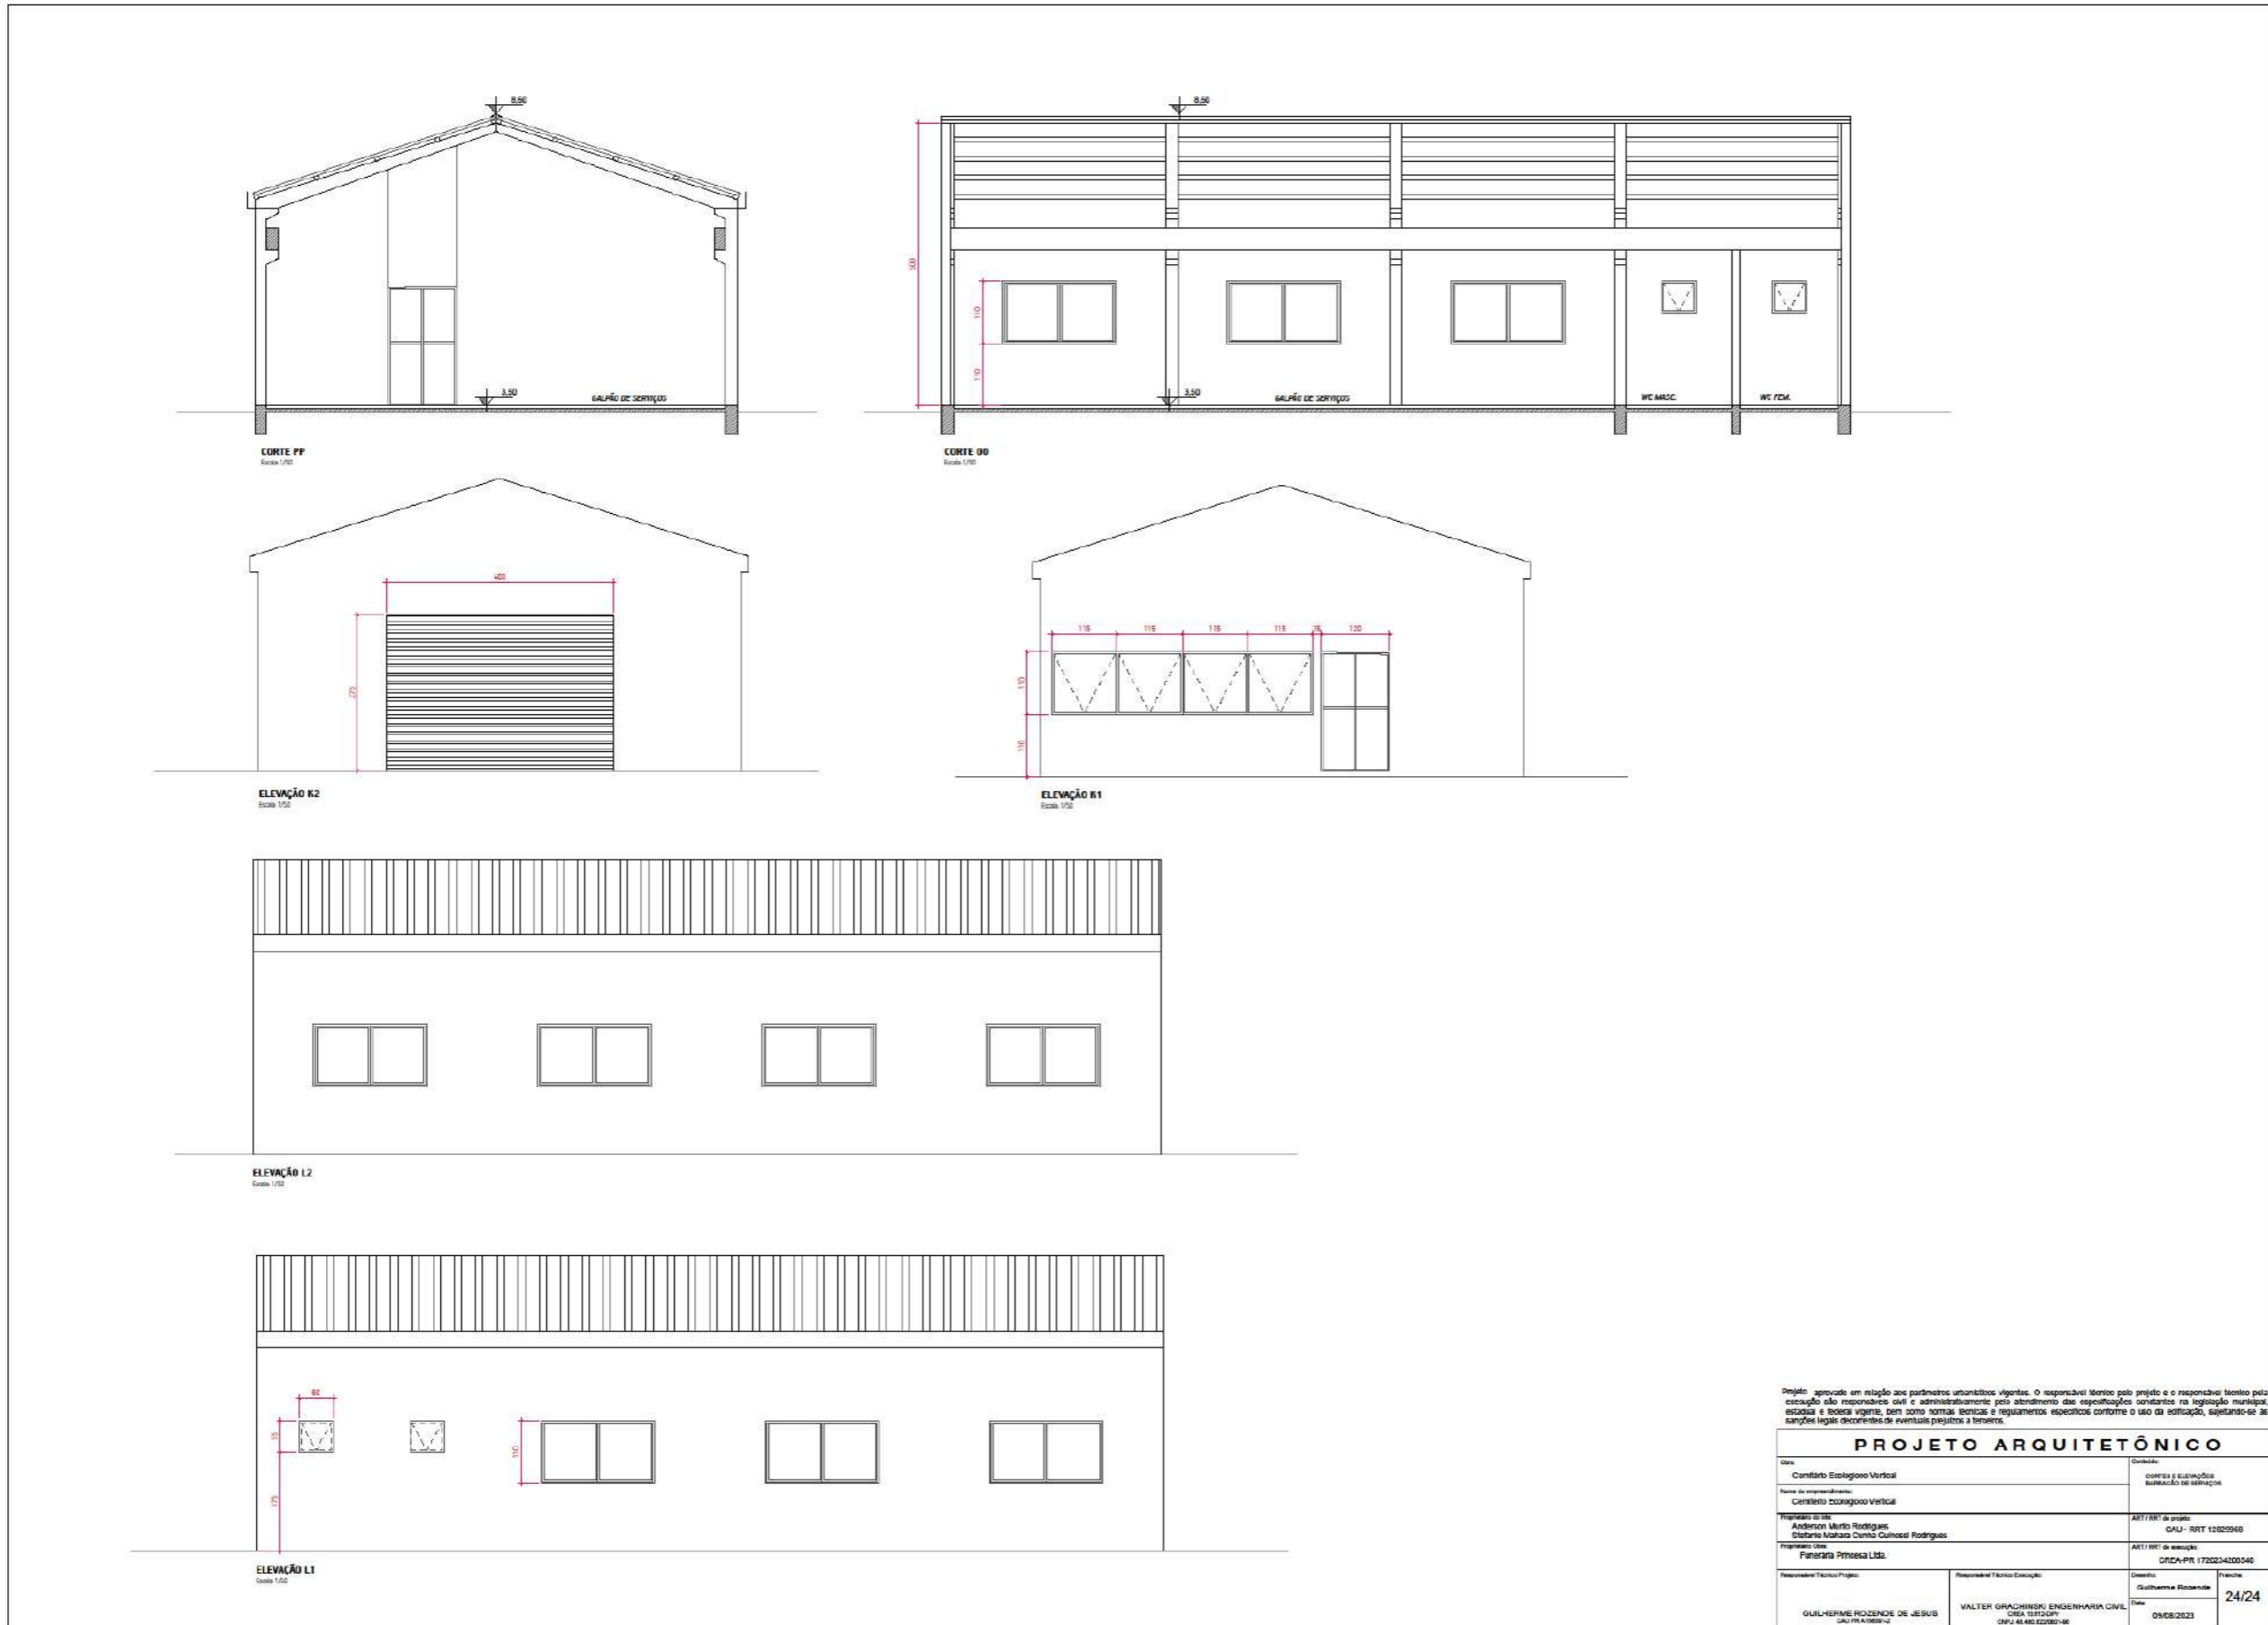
Projeto Arquitetônico – Prancha 22-24.
